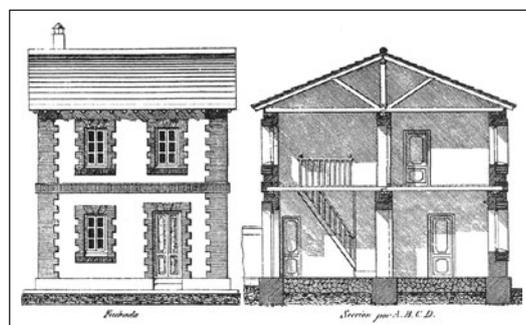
Diseño de nuevas viviendas para la reconstrucción de los pueblos destruidos por el terremoto de Andalucía de 1884 (Lopez Arroyo et al, 1980).
